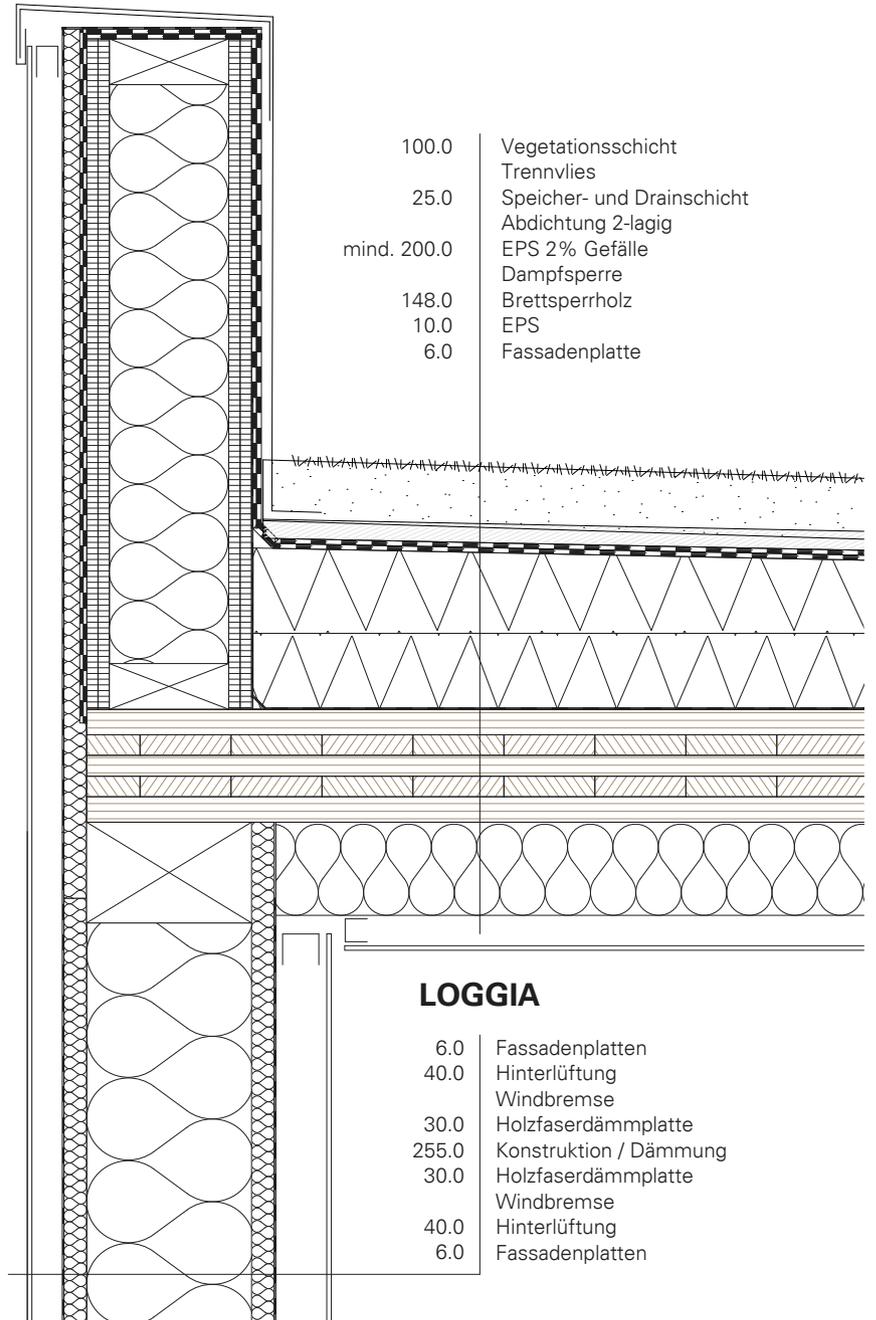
Detail 6: Vertikal Anschluss Überdeckung
